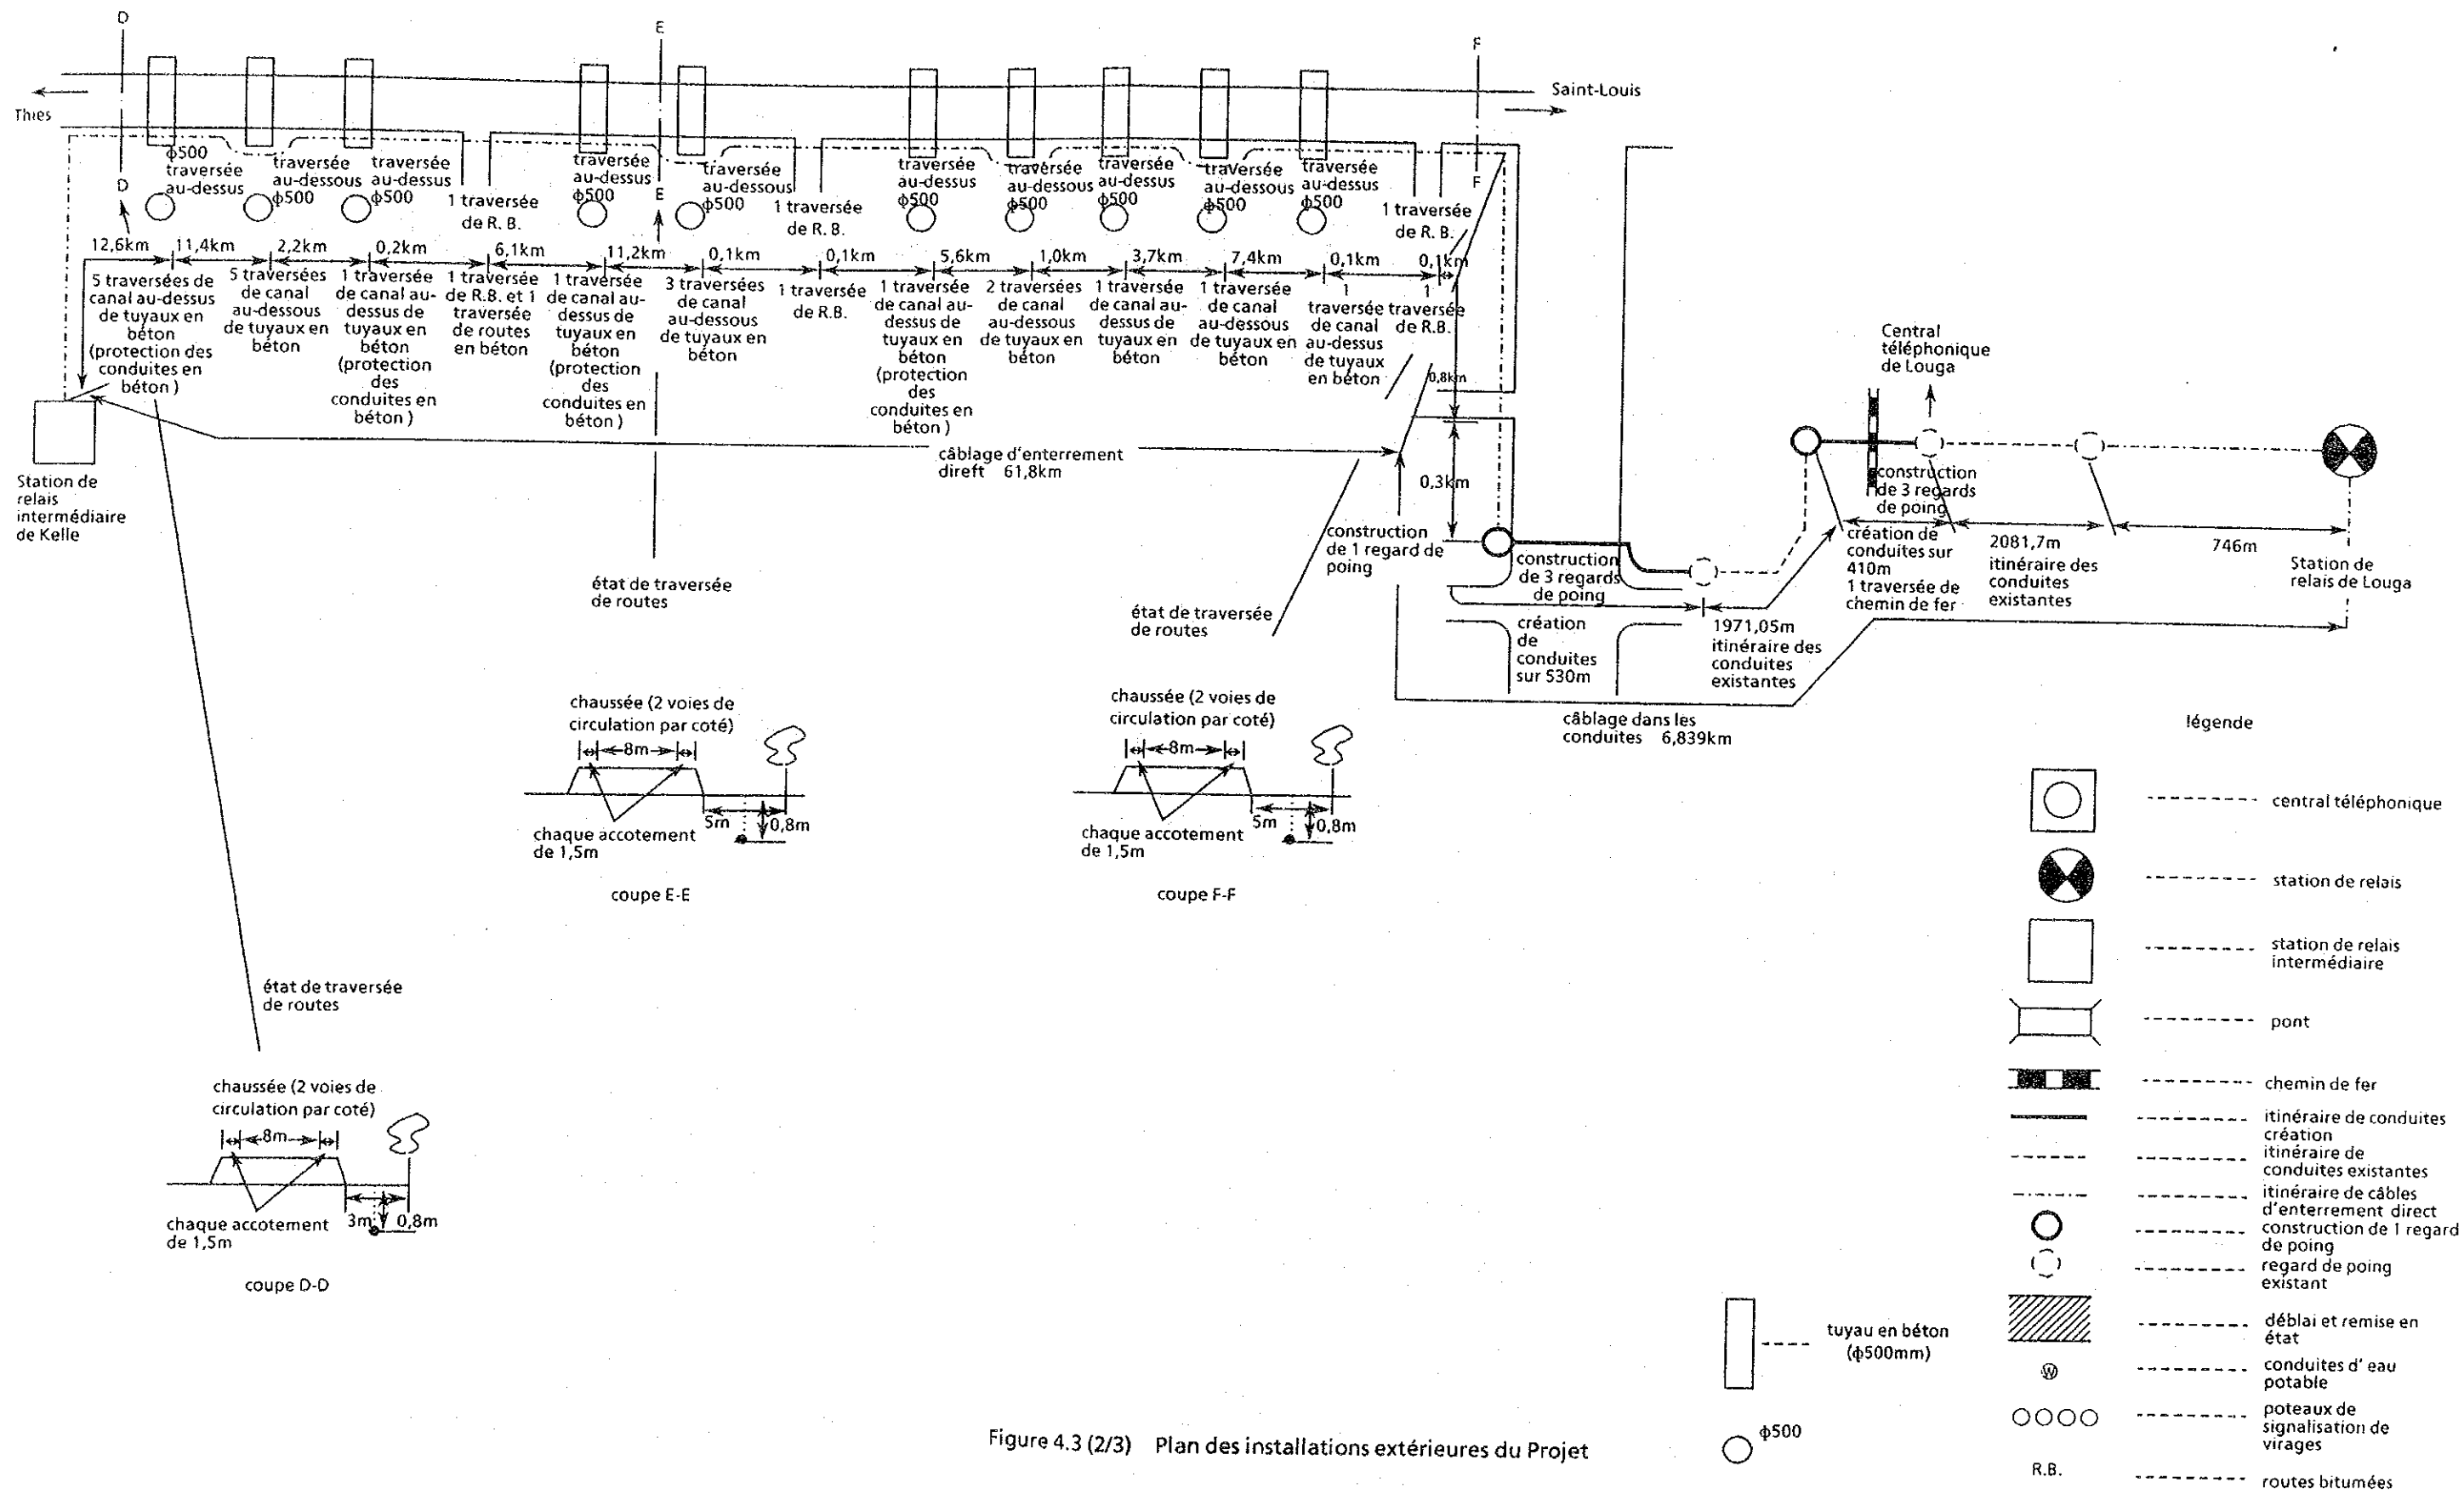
(2/3) Plan des installations extérieures du Projet
